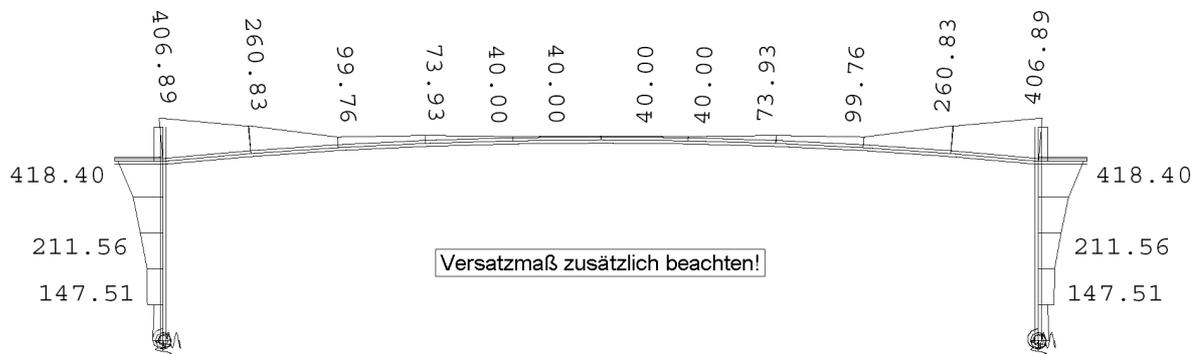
maßgebliche erforderliche Bewehrung, Rang 2 („oben“ bzw. außen) erf A_s [cm²]
